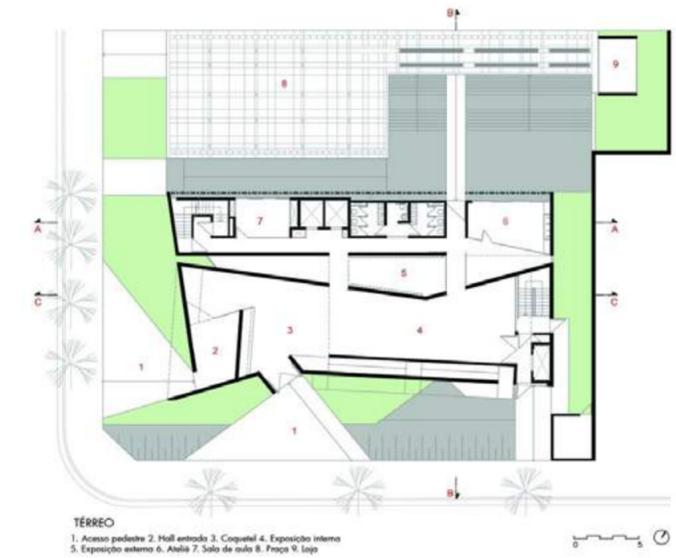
Planta Pavimento Térreo fonte: Archdaily
